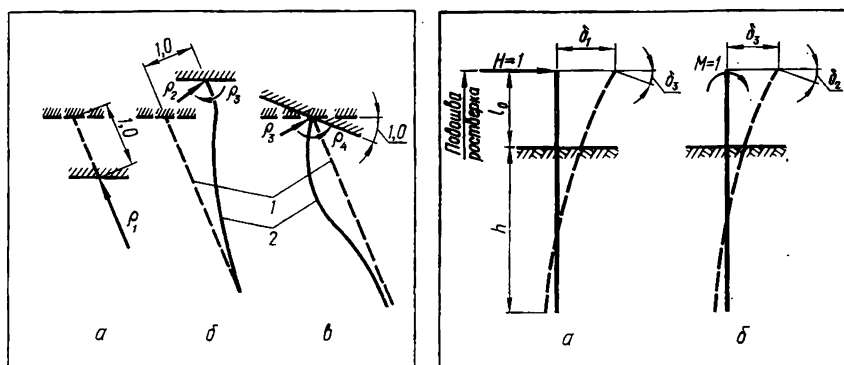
Схемы перемещений плиты фундамента, соответствующих:
